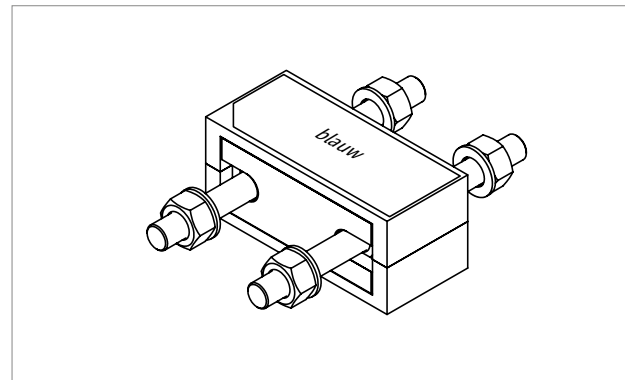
Schöck Isokorb® T type S-V-D16: Vooraanzicht
